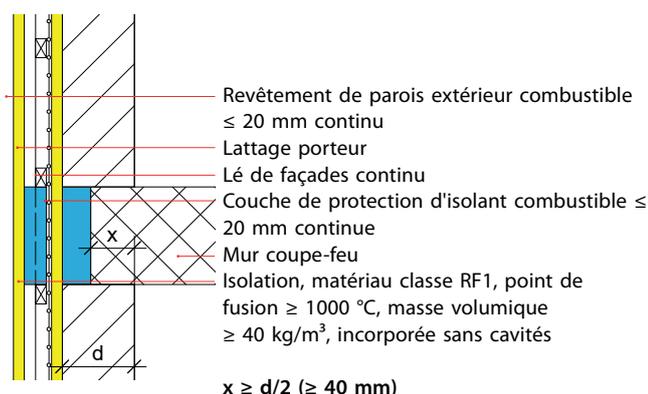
Revêtement de parois extérieur/couche de protection isolante combustible ≤ 20 mm; raccordement de murs coupe-feu au mur extérieur (dessin d'après AEAI)
